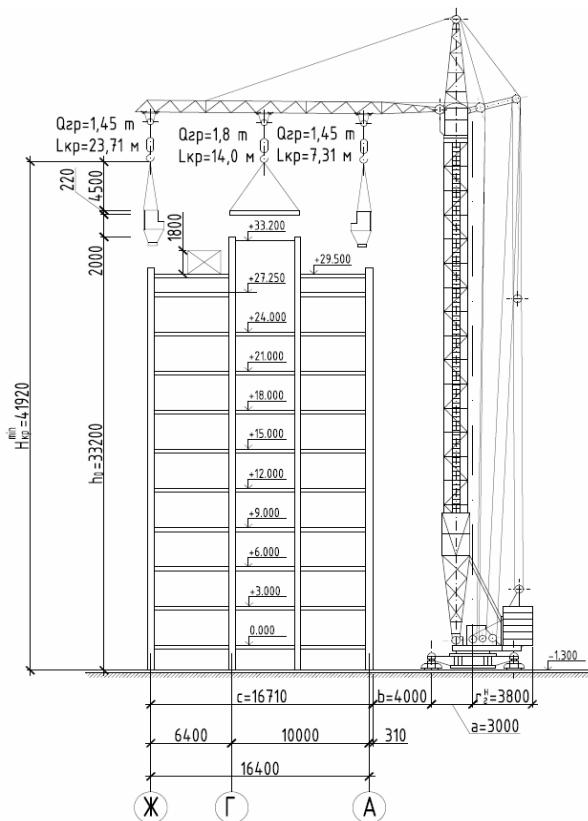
Уточненная расчетная схема оптимального варианта башенного крана с привязкой к зданию
